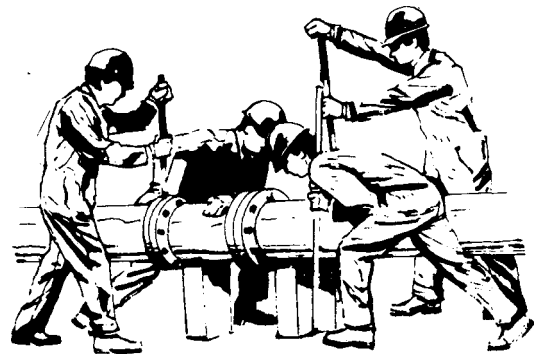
Desmontaje de una sección o "carrete" de tubo para instalar bridas ciegas
